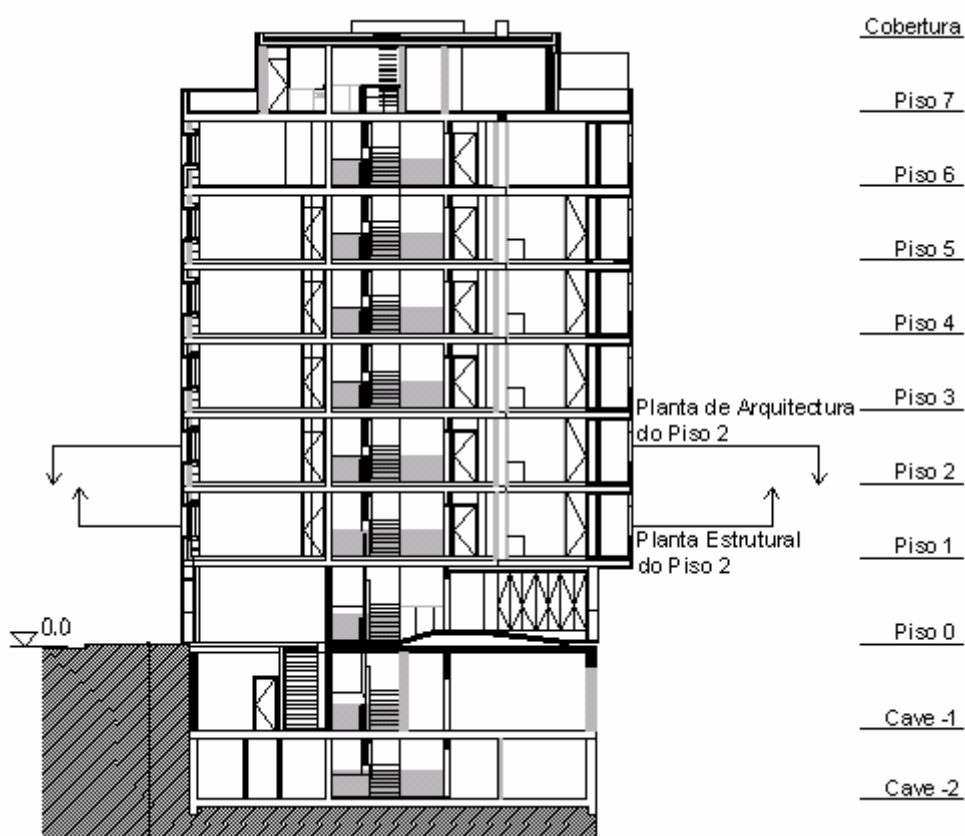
Correspondência entre as Plantas Estruturais e as de Arquitectura
